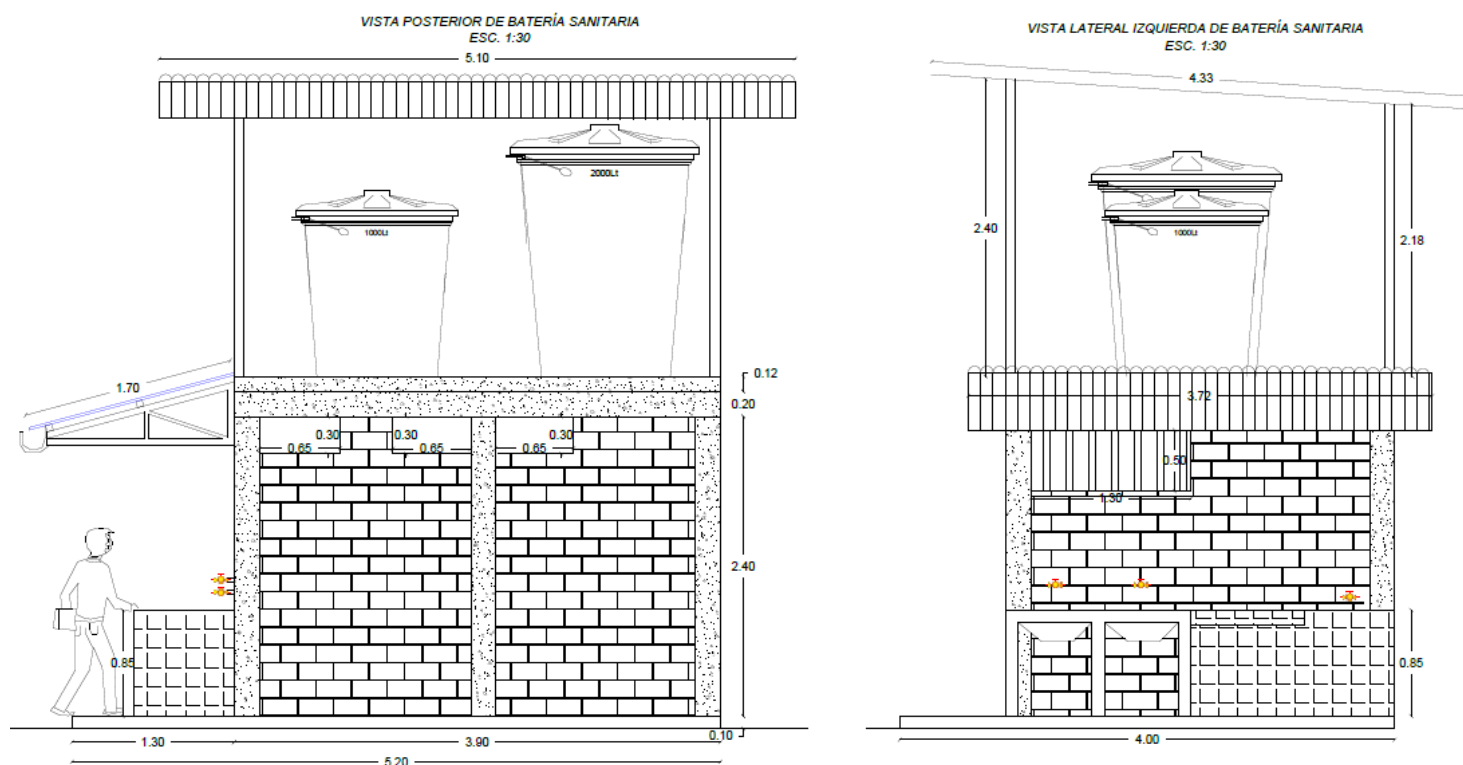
Plano vista posterior y vista lateral izquierda batería sanitaria Casa Cabildo
